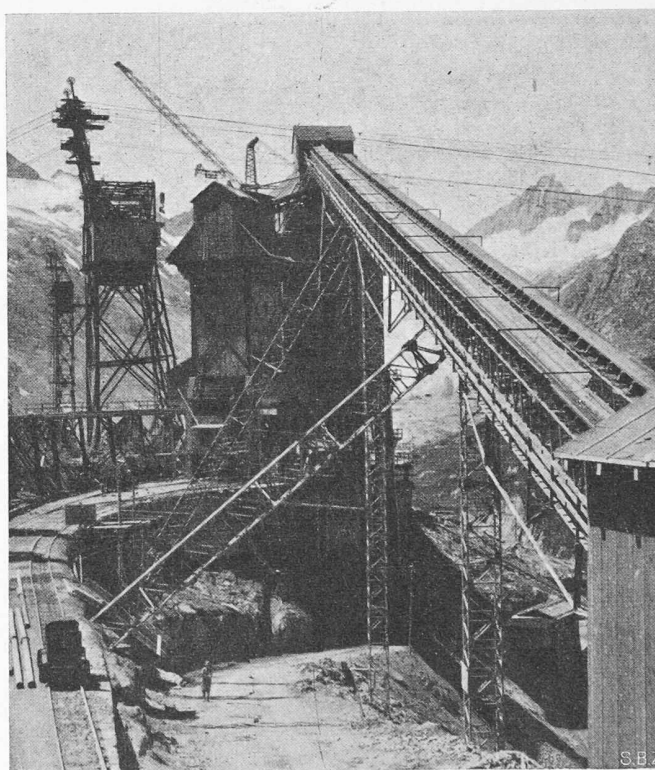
Gesamtansicht, Blick gegen den Betonmischturn
